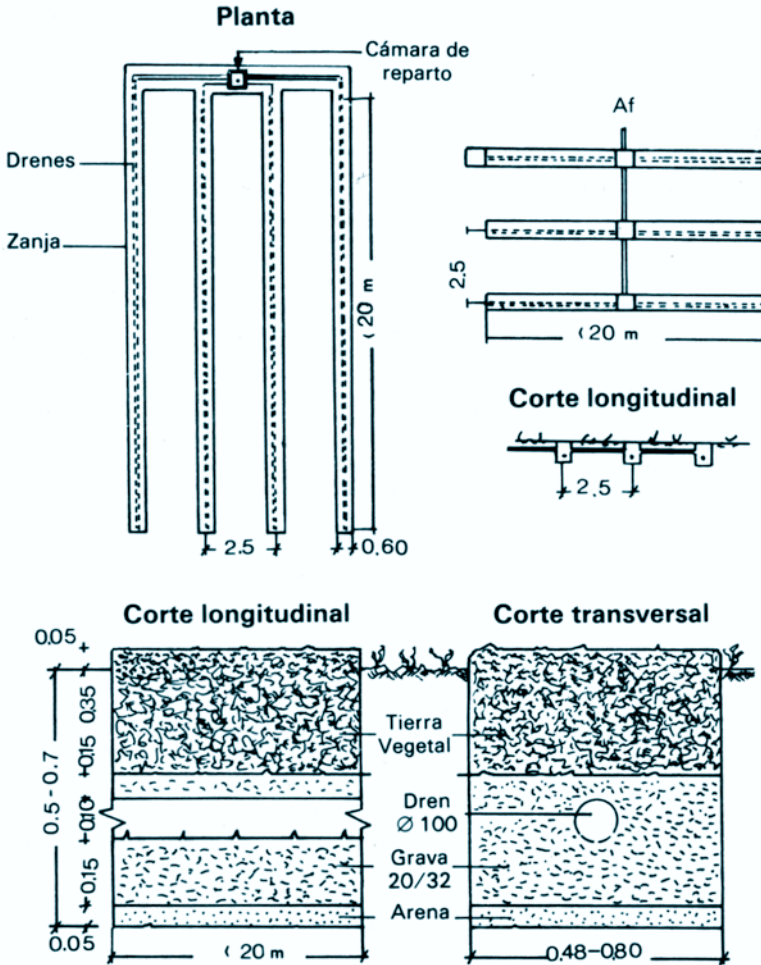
Características constructivas de las Zanjas Filtrantes (Rouhart, J., 1986)
